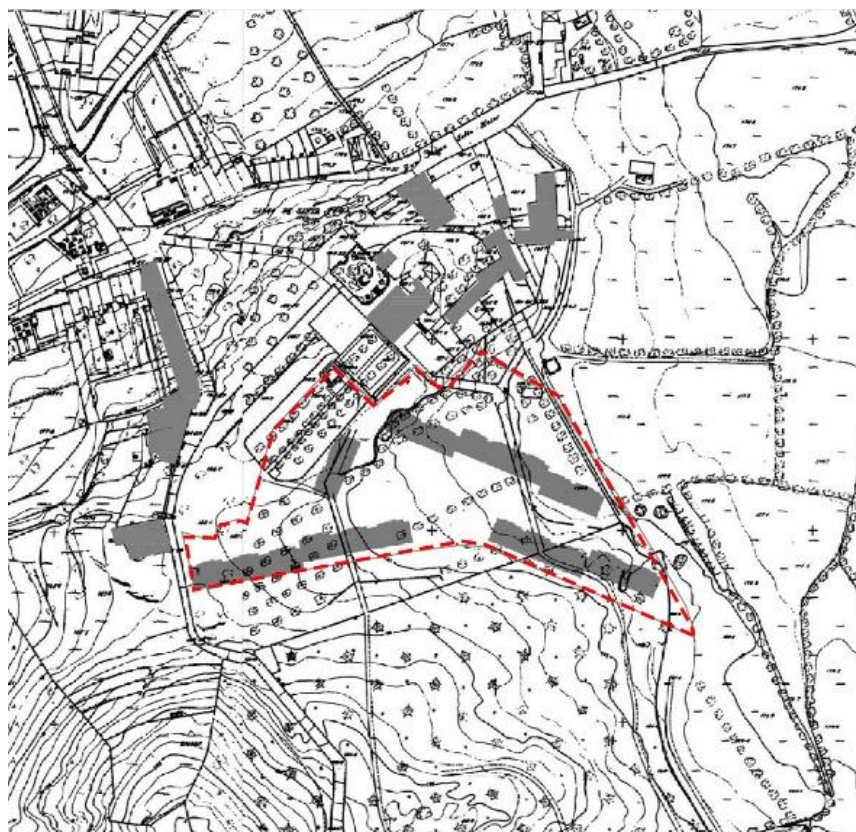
Planta do ano de 1936. Localização do Bairro Social de Santa Tecla. Indicação dos edifícios já existentes em 1936 e que ainda hoje existem.
